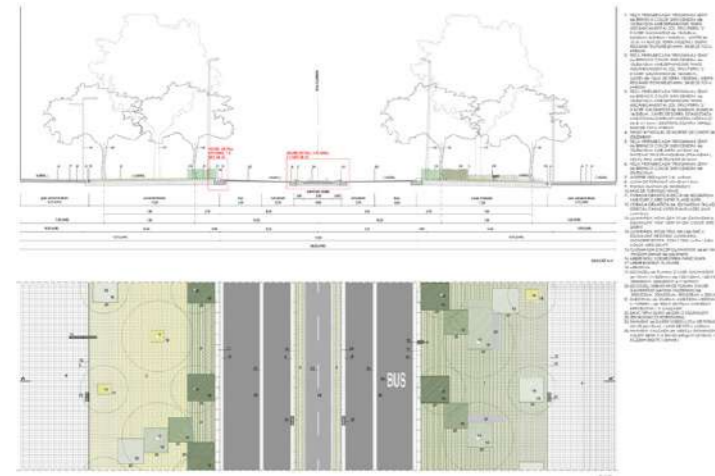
Planta y alzado transversal de la avenida con detalles constructivos. FUENTE: Adriá Goula, sin fecha.
